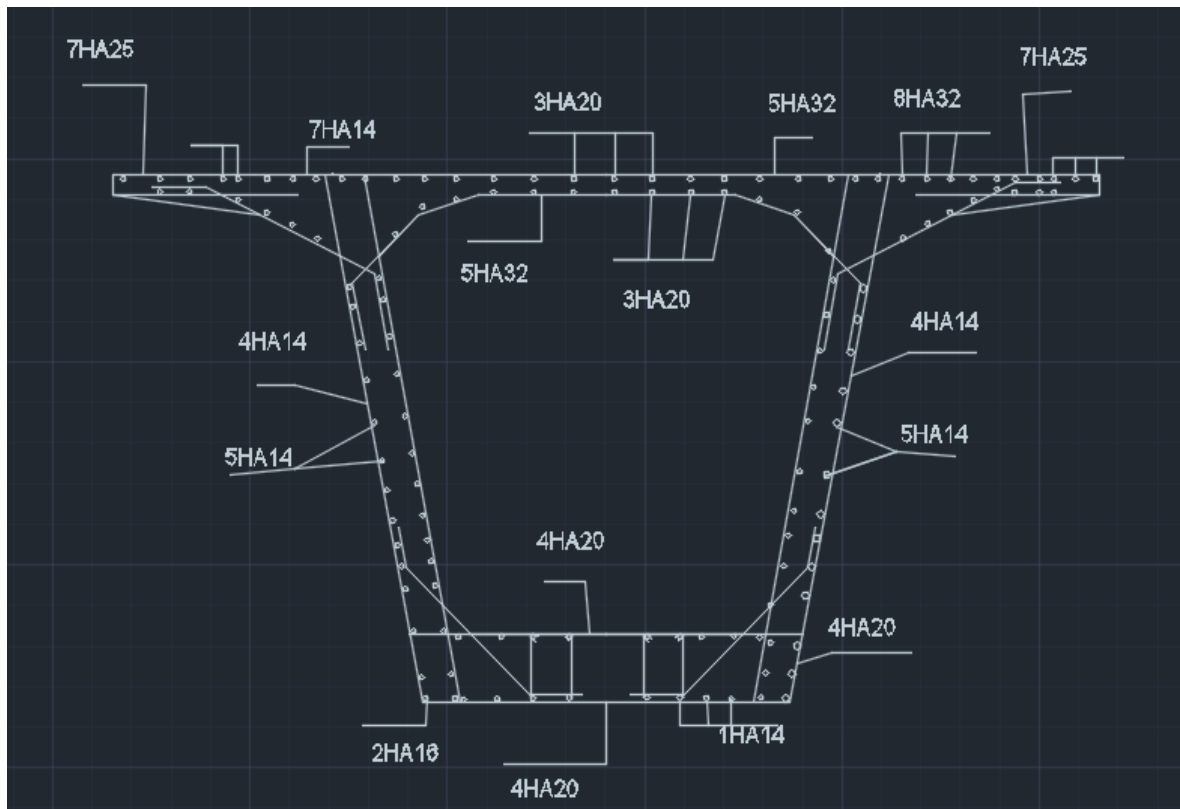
Schéma de Ferrailage du voussoir sur pile
